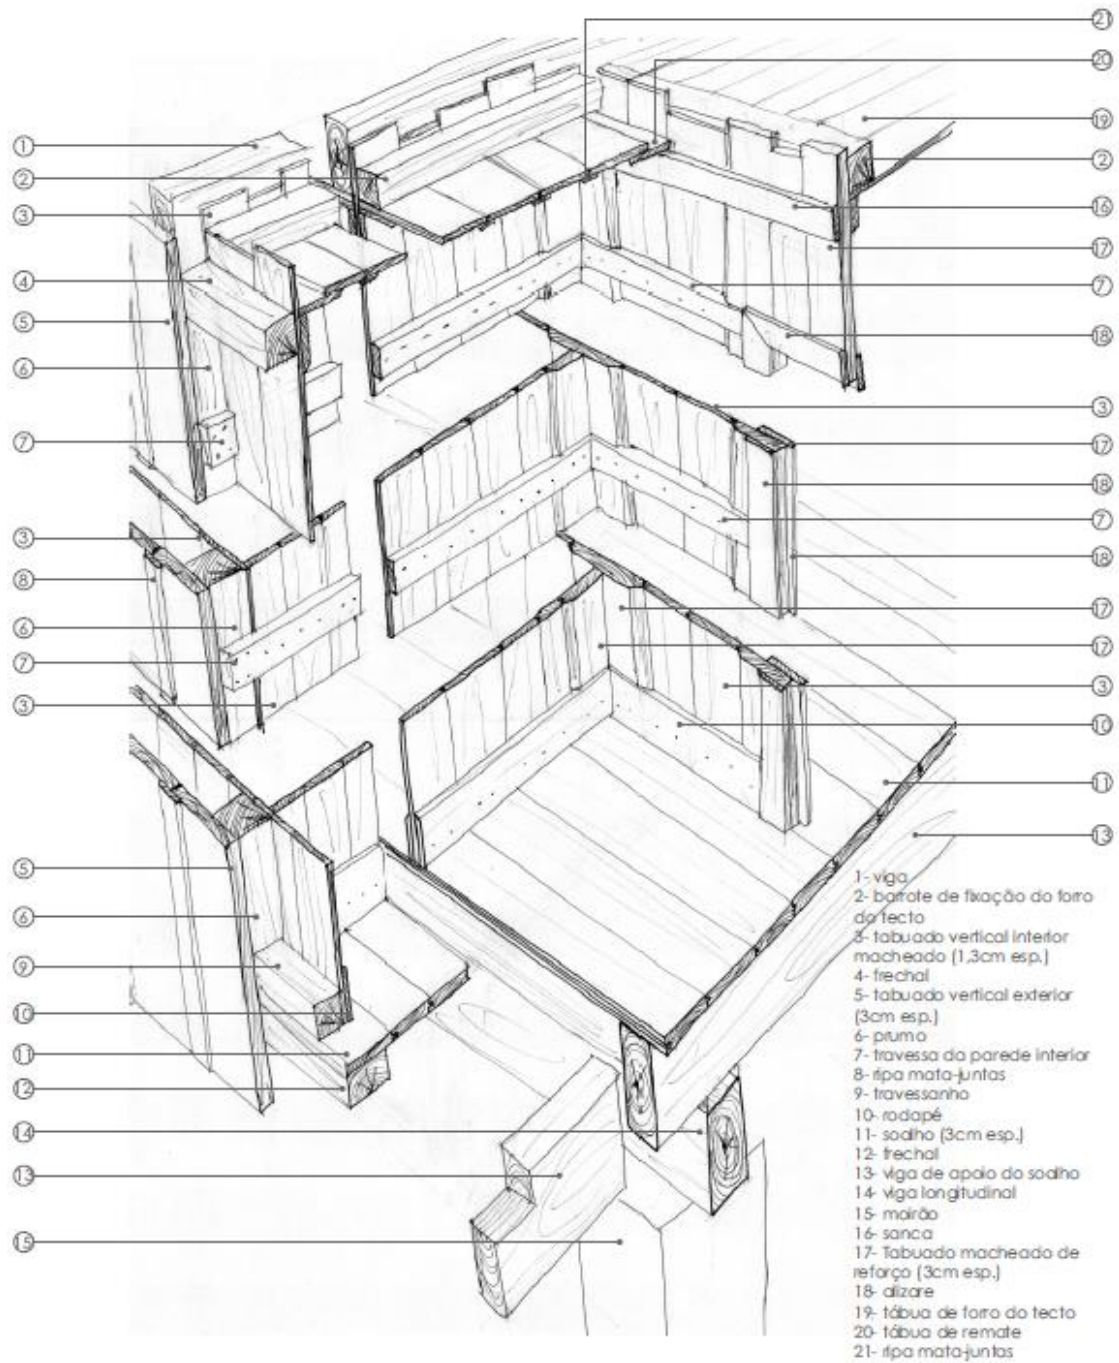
Pormenor tipo da parede interior (fonte: Moutinho (2007))
